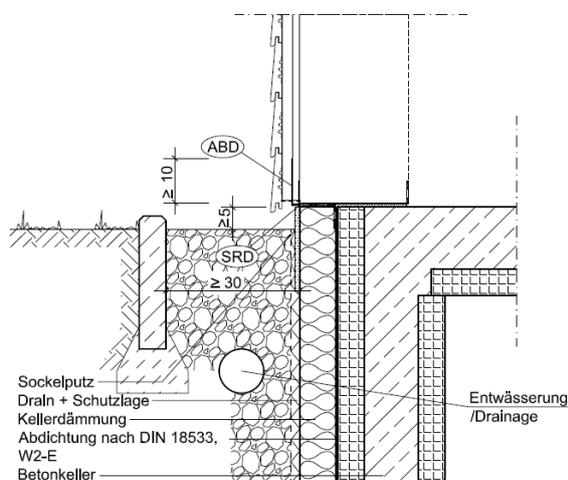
Kiesstreifen mit Holzfassade und Abdichtung gem. DIN 18533
